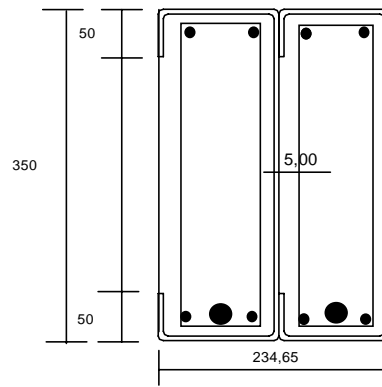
Seção Transversal da Viga VD2 Especificada
